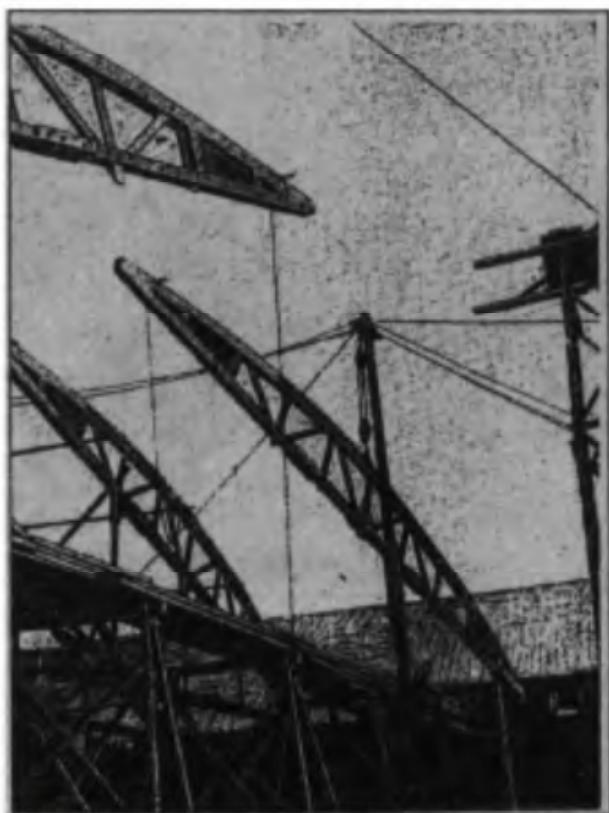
Монтаж цельнодеревянных сегментных ферм при помощи мачт
